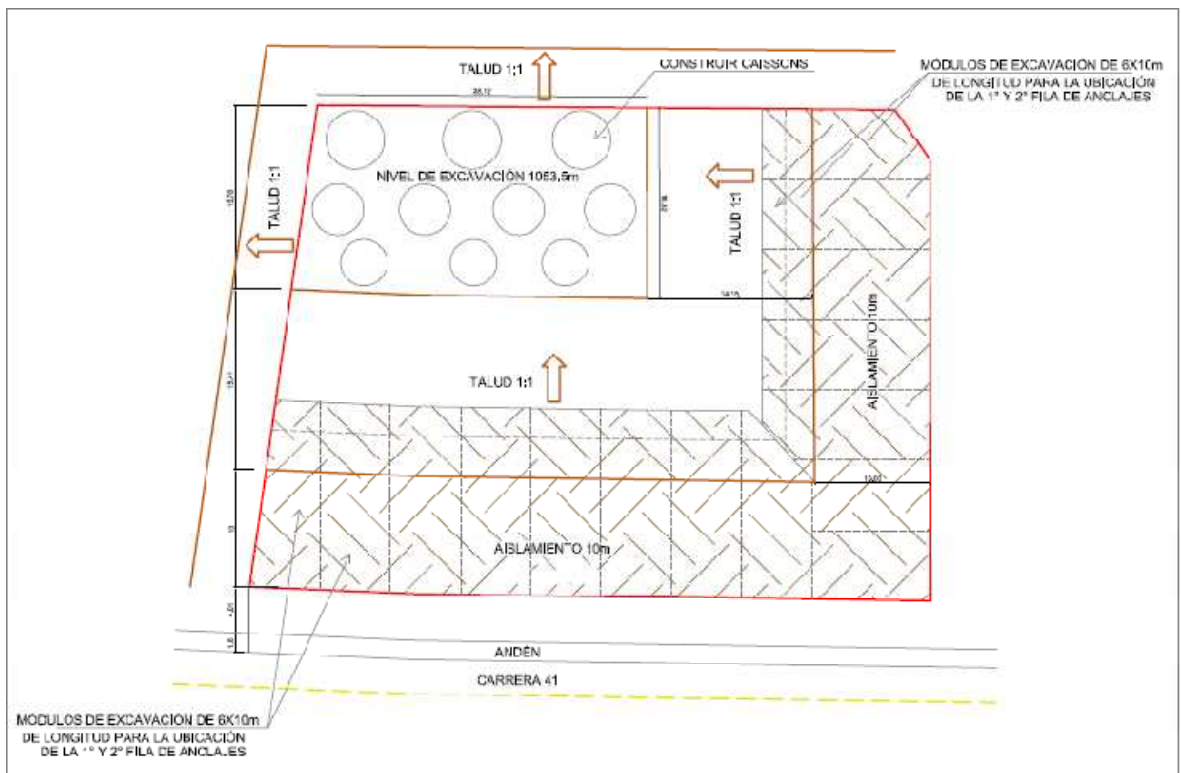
Paso 2.9: Se repiten los pasos 2.2 y 2.6 para la instalación de cada una de las filas de anclajes, se llega hasta el nivel de excavación, terminando así la construcción de la pantalla.
